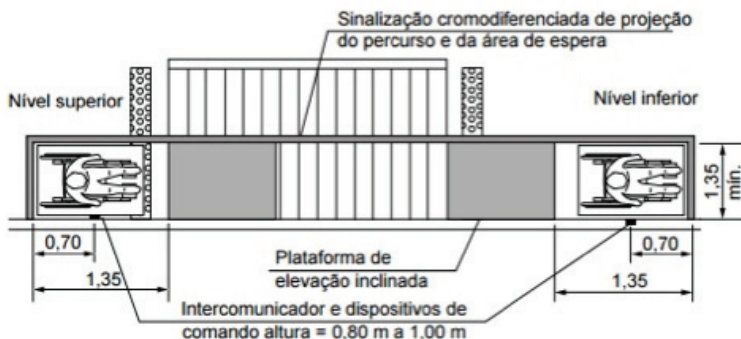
Sinalização de piso junto à plataforma de elevação inclinada – vista superior
